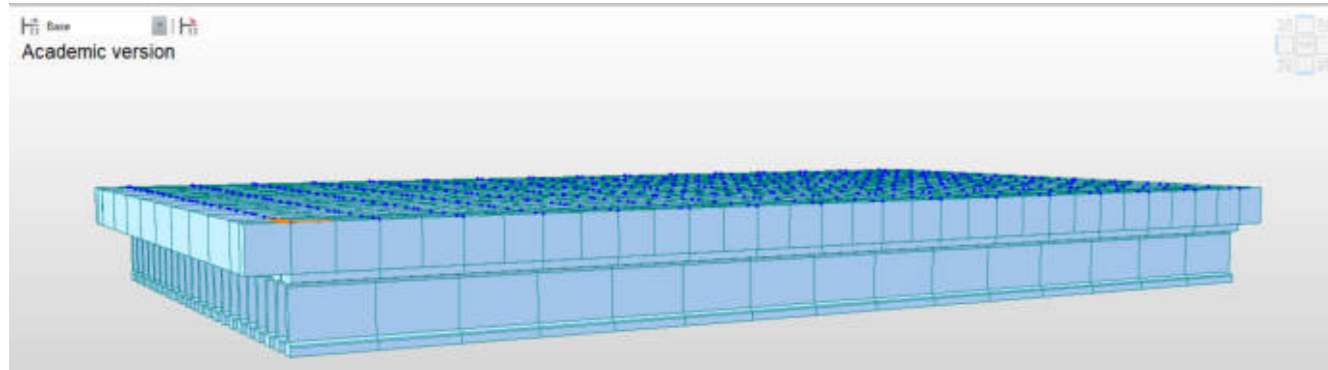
Inserción de las barras transversales que conforman el emparrillado de la losa superior con propiedades de hormigón 17,5 MPa
